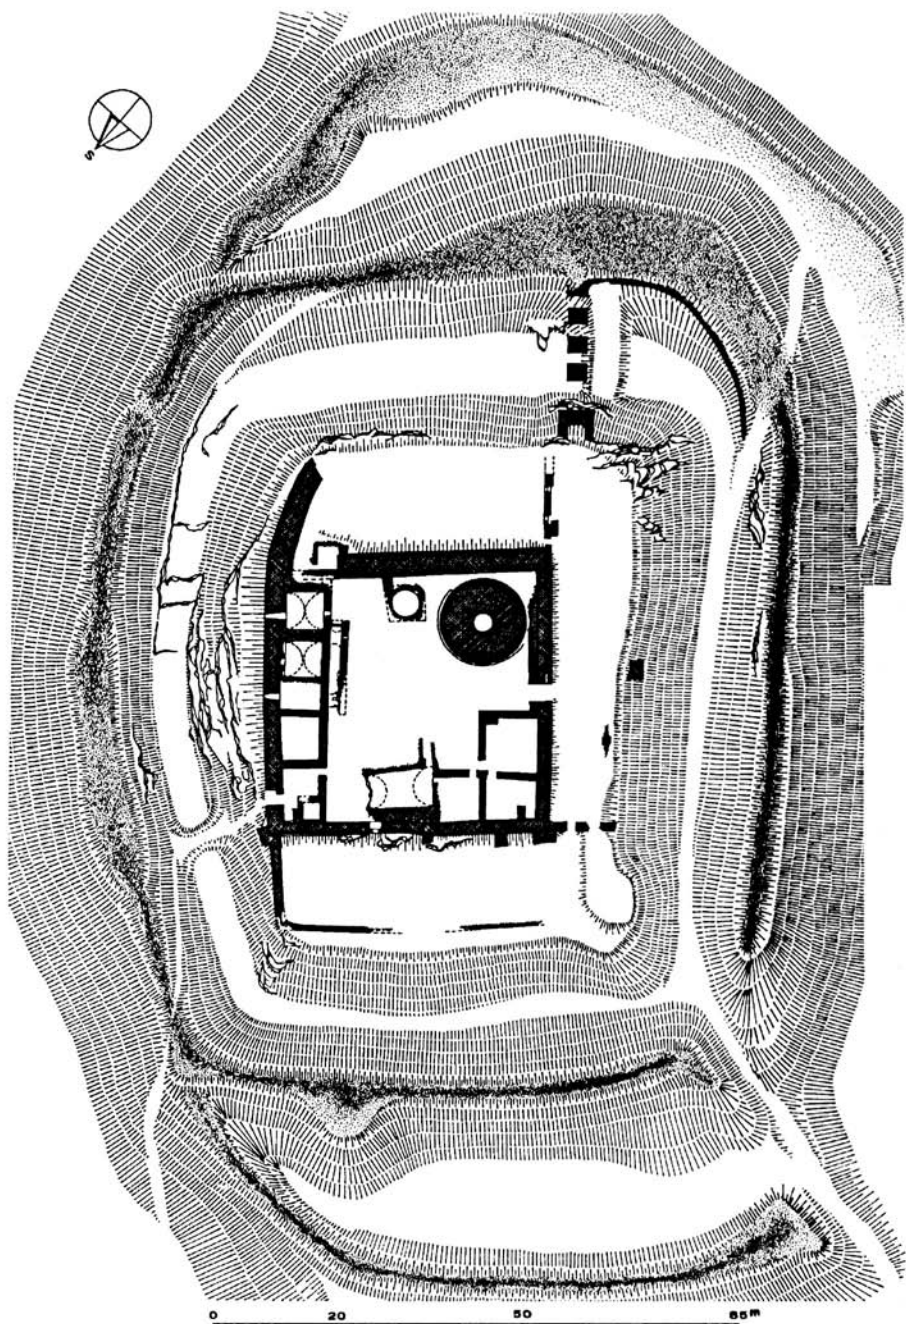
Grundriß der Burg Cvilin/Lobenstein.
